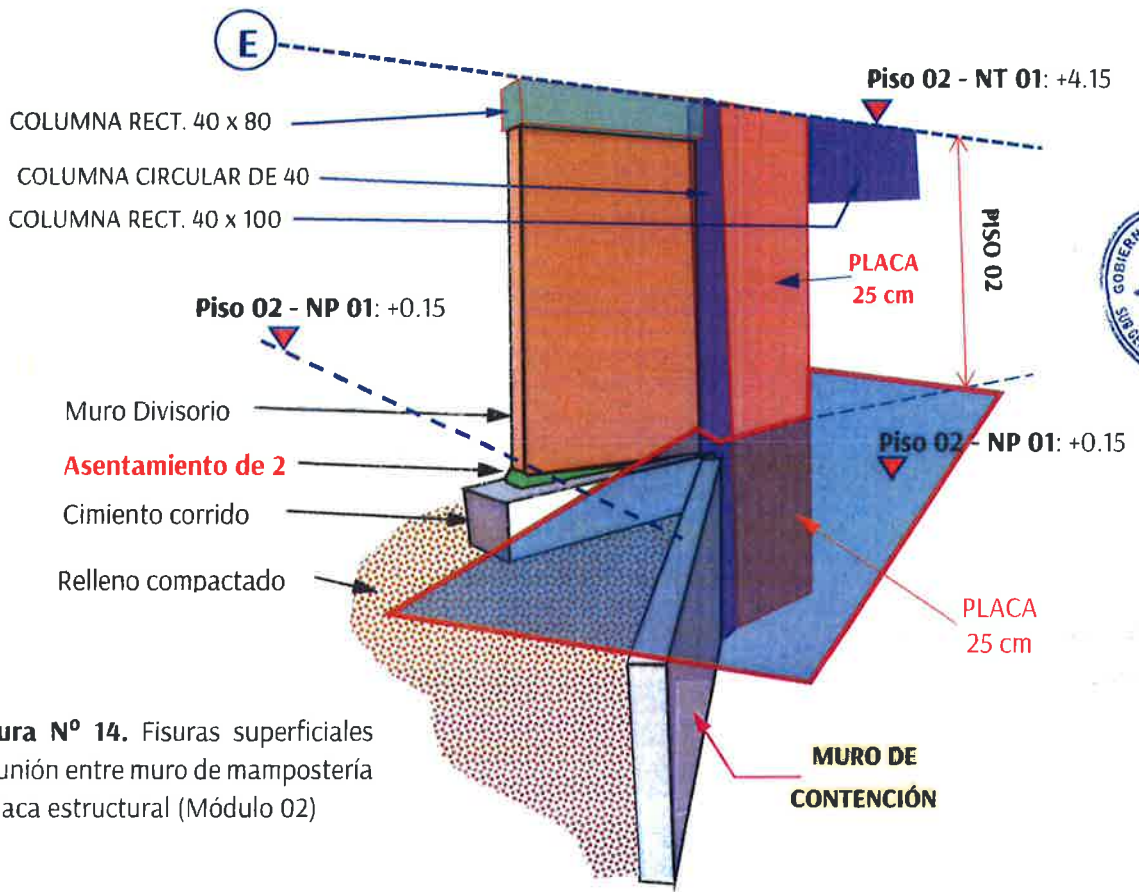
Fisuras superficiales de unión entre muro de mampostería y placa estructural (Módulo 02)
